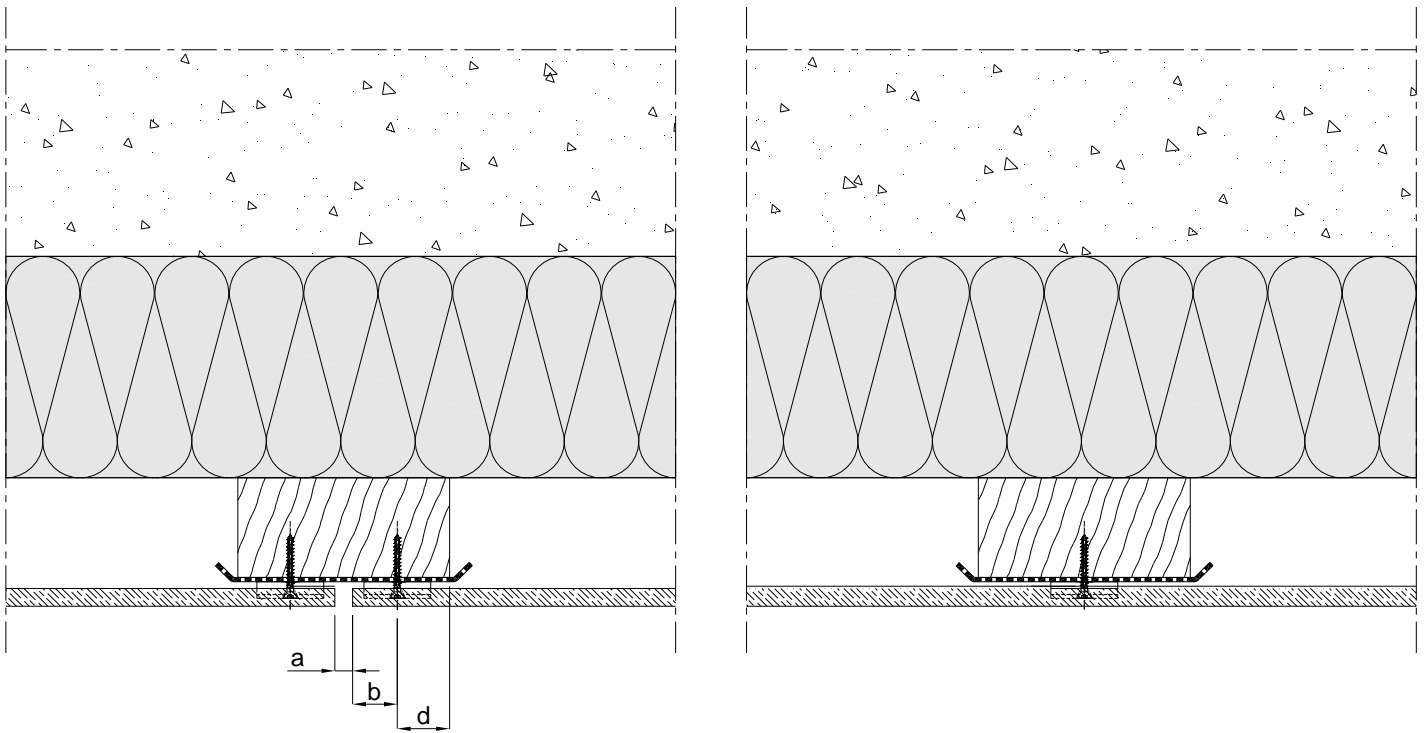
Pose horizontale - Joint horizontal (coupe verticale) et cale de montage
